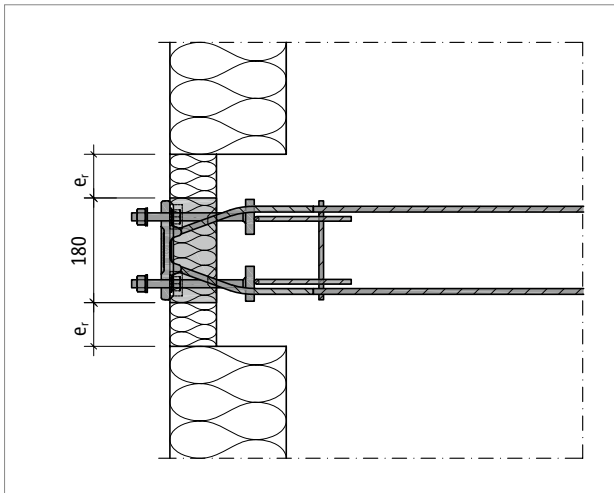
Schöck Isokorb® T type SQ : distances aux bords
